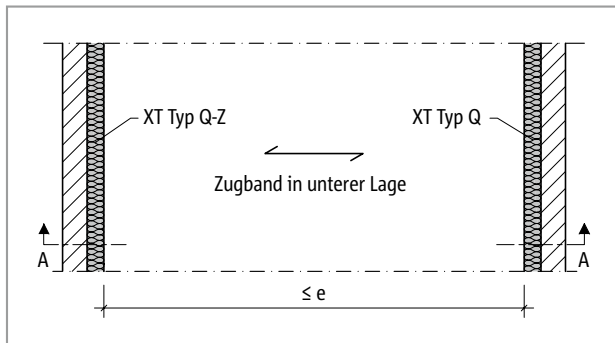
Schöck Isokorb® XT Typ Q-Z, Q: Einachsig gespannte Stahlbetonplatte
